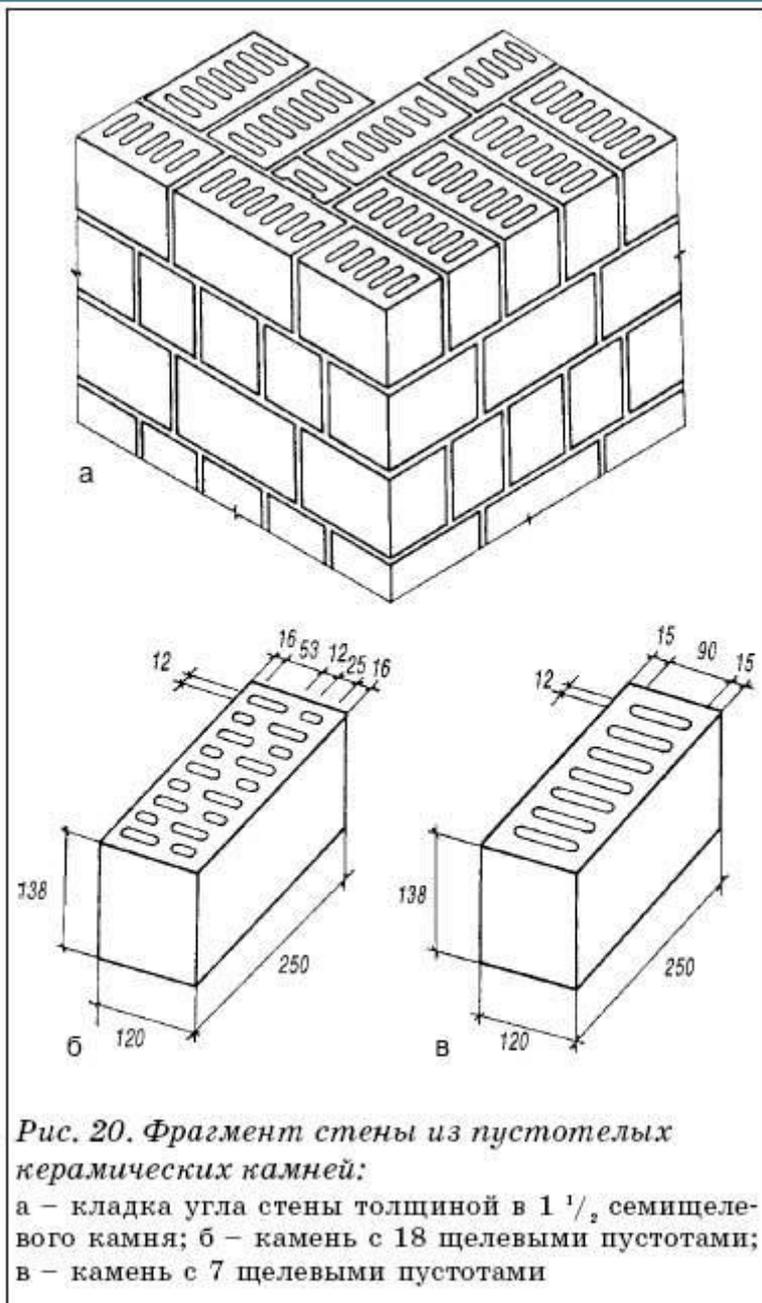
Фрагмент стены из пустотелых керамических камней:
